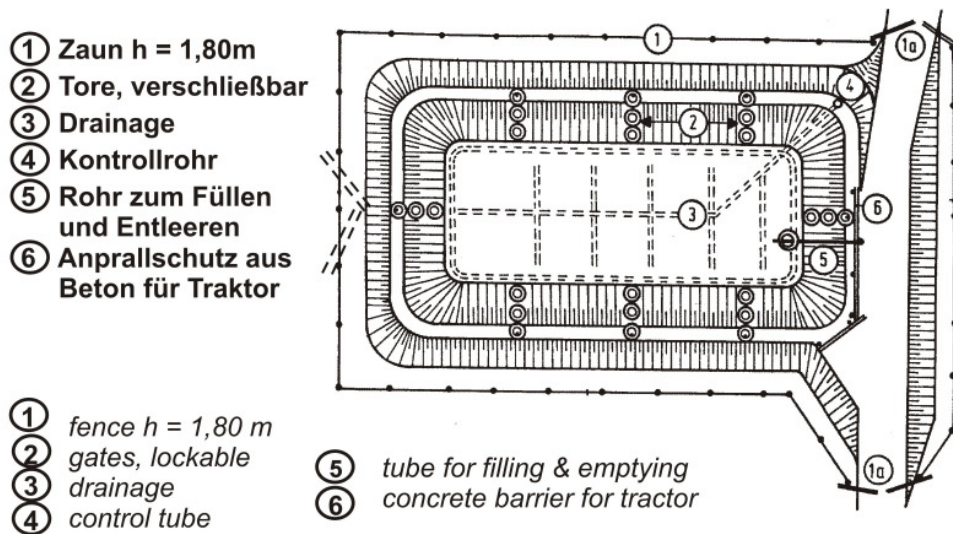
Grundriss eines mit Kunststoff ausgekleideten Erdbeckens in der FAL
